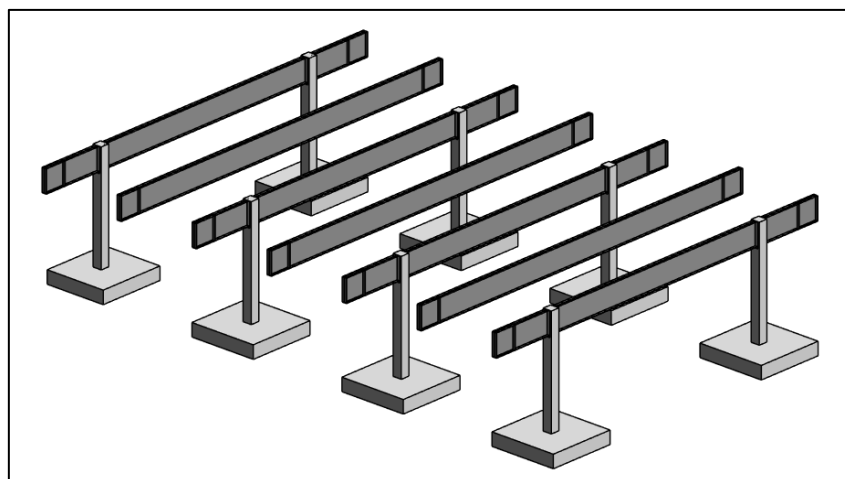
Colocación de vigas inferiores de marcos metálicos. Fuente: Autor.
